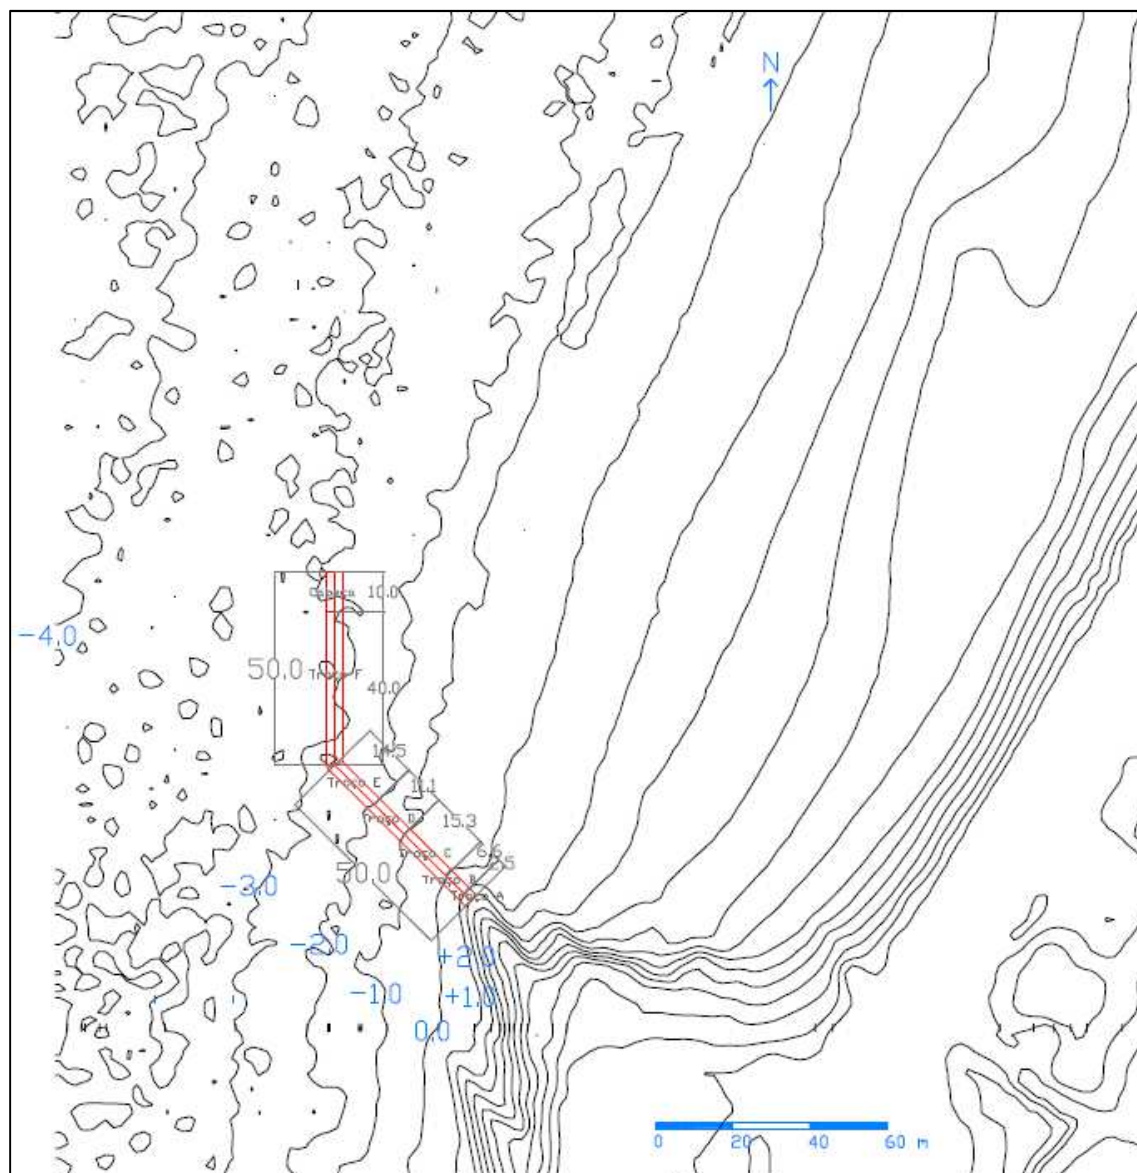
Planta de implantação de esporão em "L" para a hipótese de 100 m de comprimento
